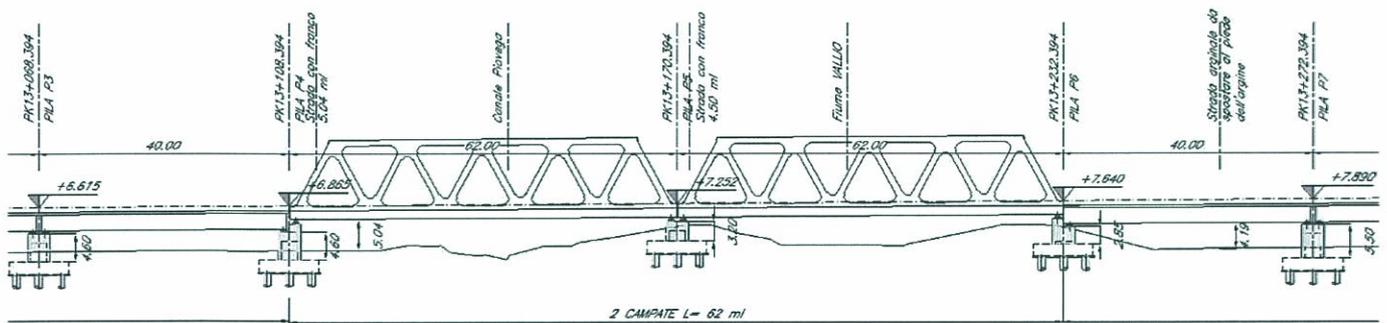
Prospetto dell’attraversamento del Canale Piovega e del Fiume Vallo.
